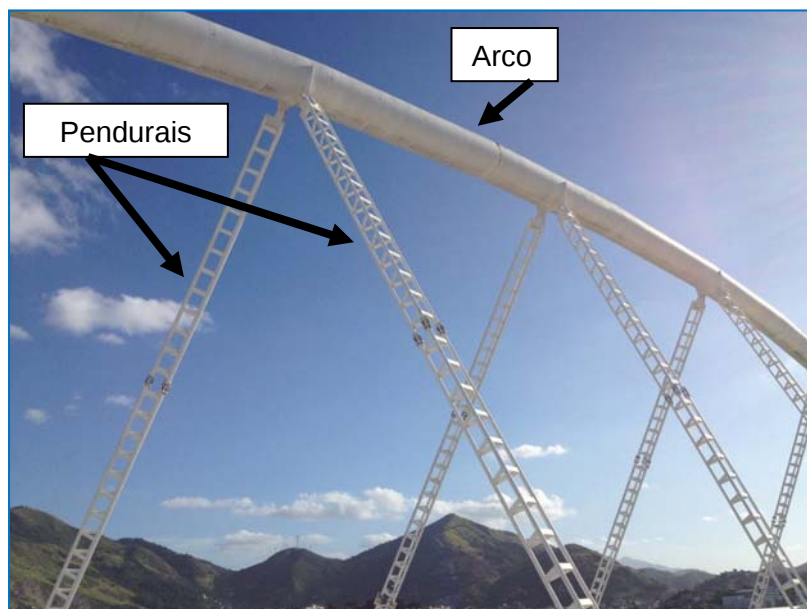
Detalhes dos pares de pendurais que ligam as tesouras ao arco primário
